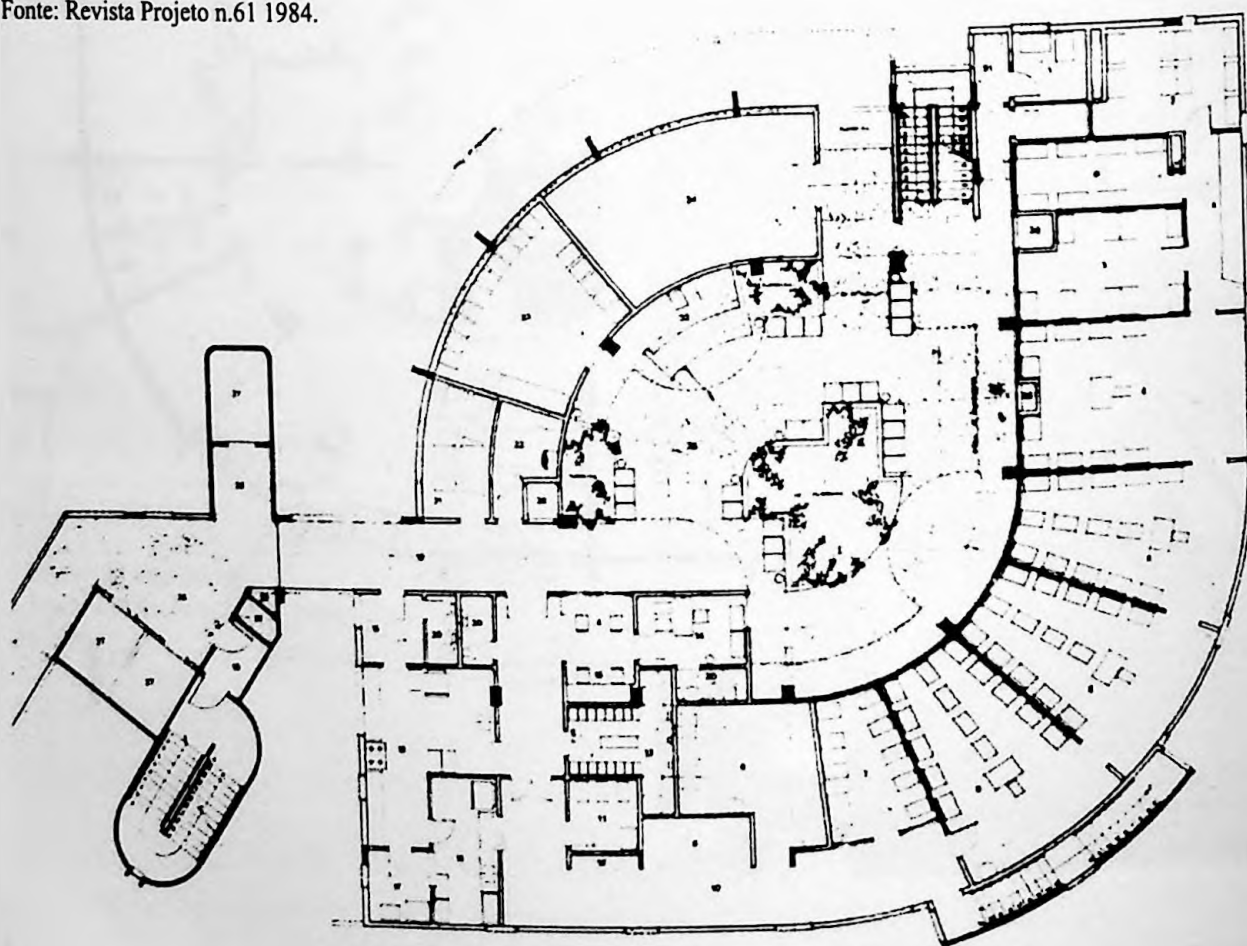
2° pavimento Centro Cirúrgico e Esterilização.
